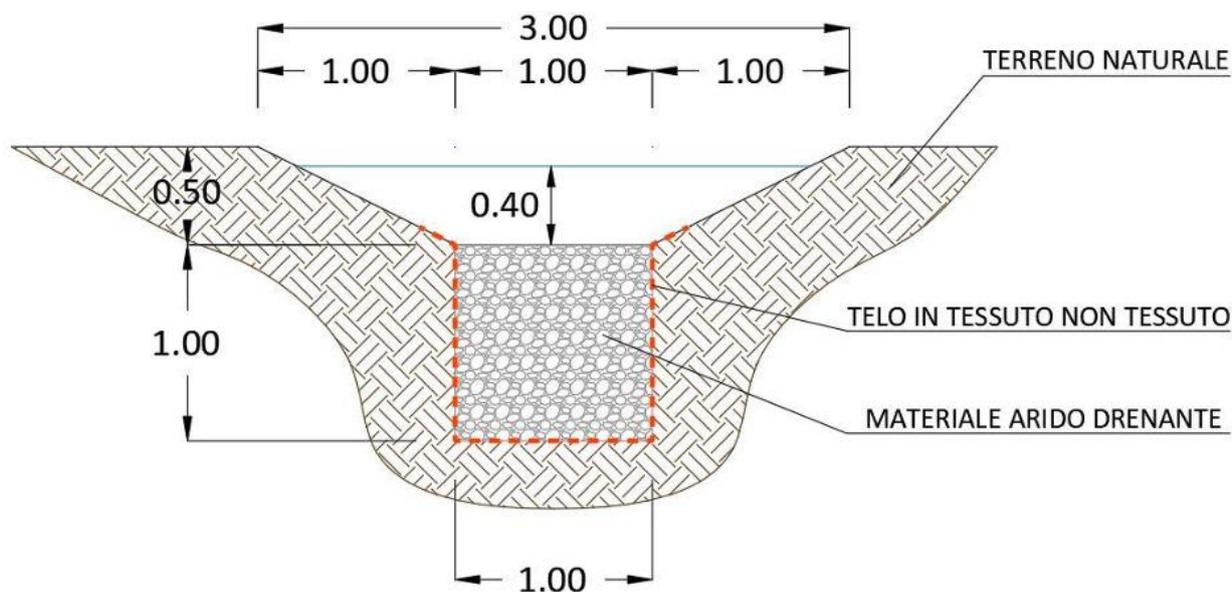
SEZIONE TRASVERSALE SISTEMA FOSSI + TRINCEE
